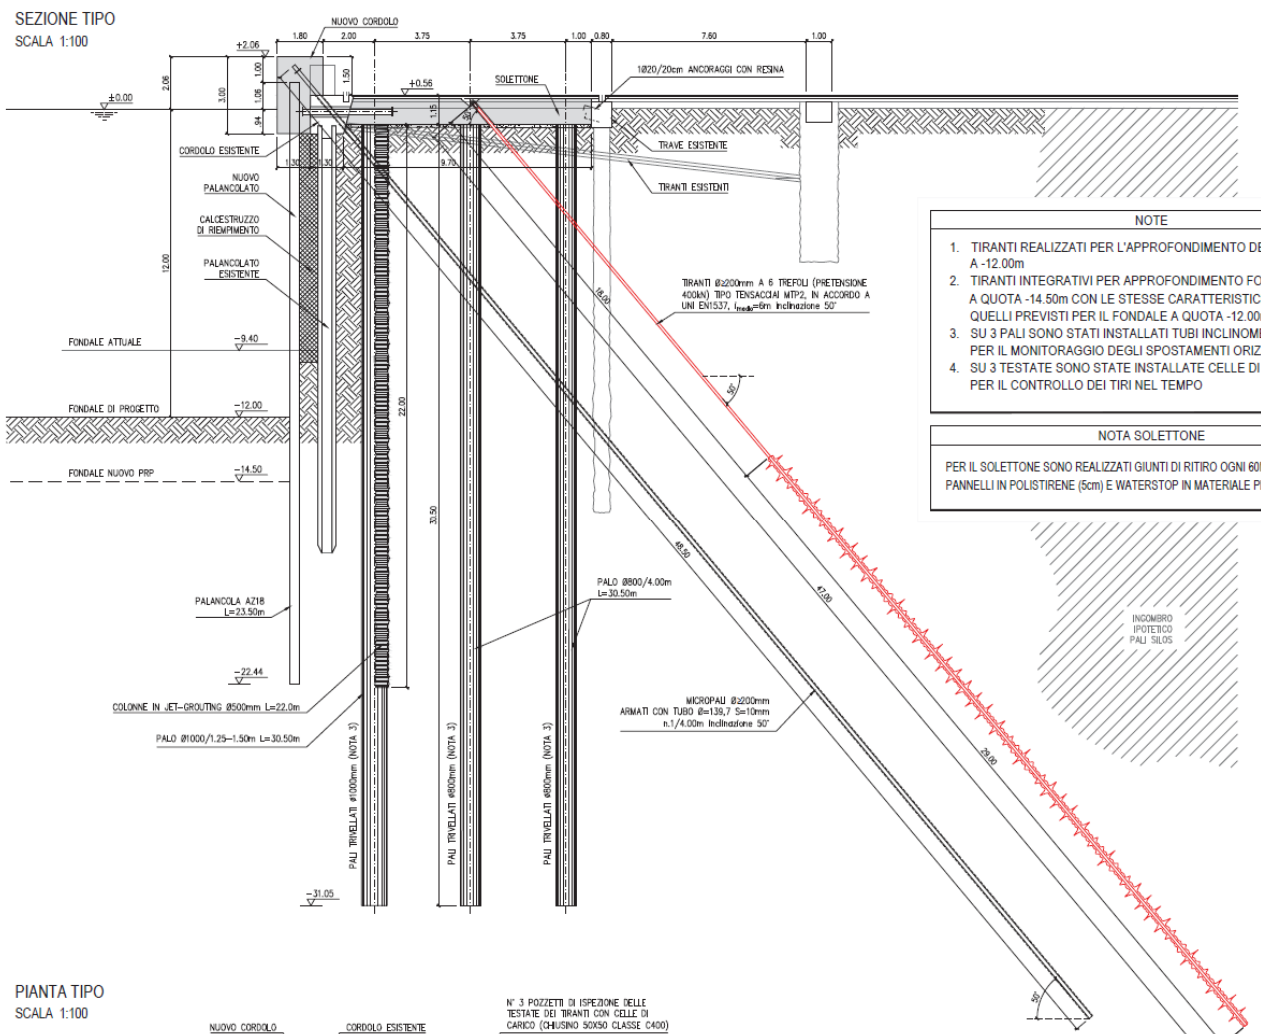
Sezione tipo della banchina "A" nella situazione attuale
